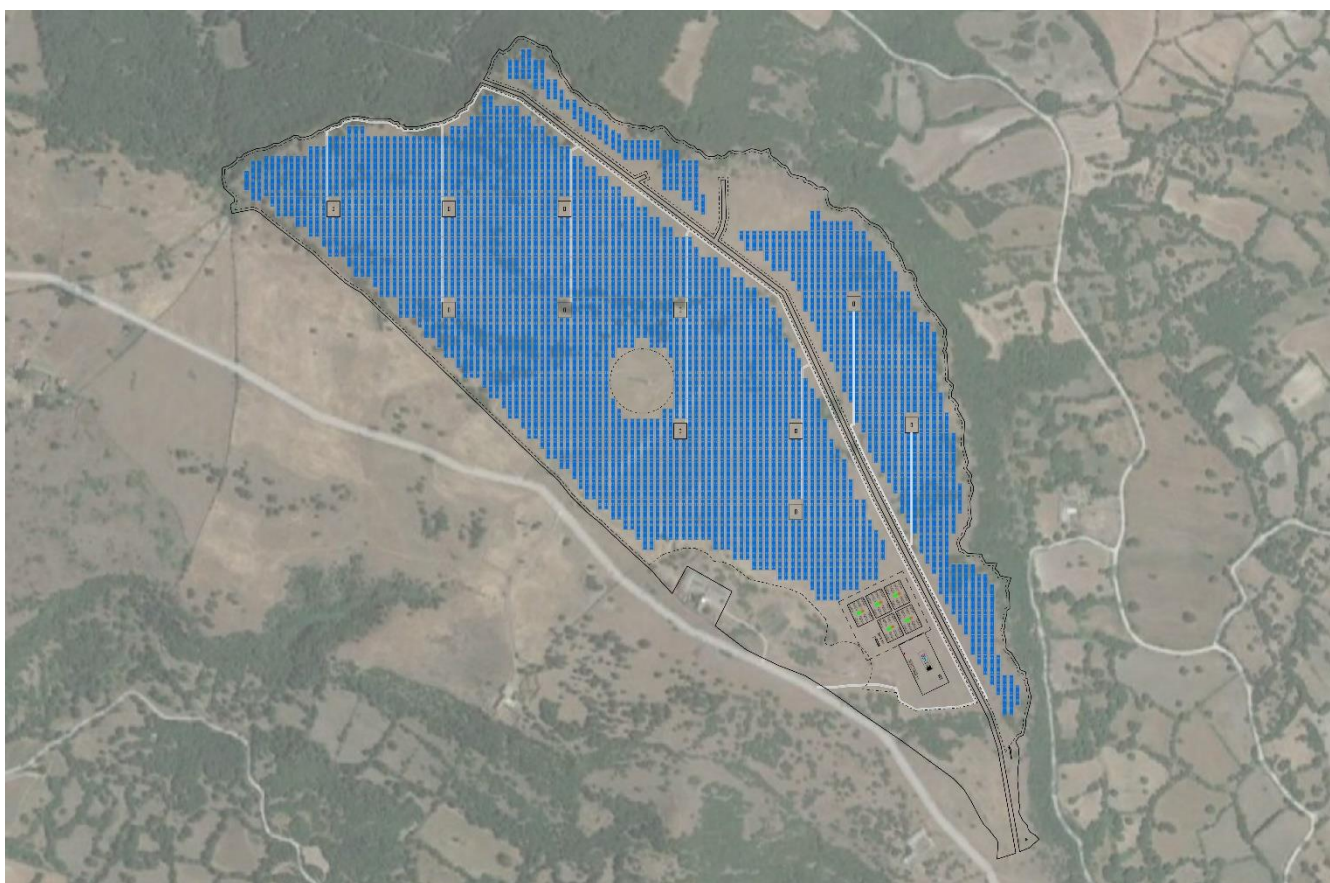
Ortofoto con layout e perimetrazione del sito di interesse.
